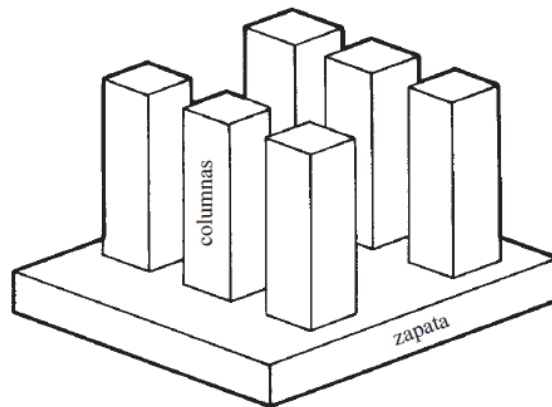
Losa de cimentación (McCormac & Brown, 2016).
